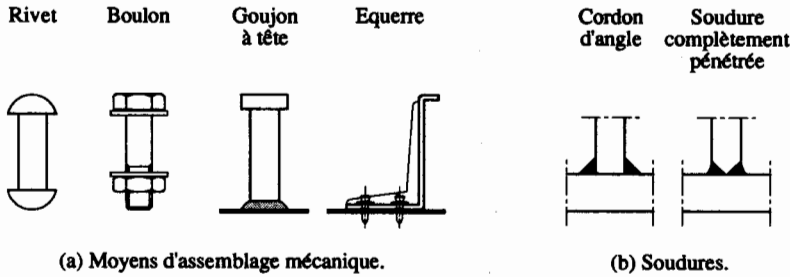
Moyens d'assemblage mécanique et soudures.
